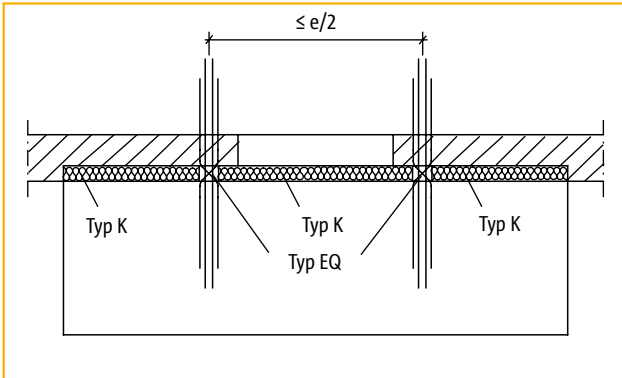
Grundriss Balkon frei auskragend + Typ K + Typ EQ
